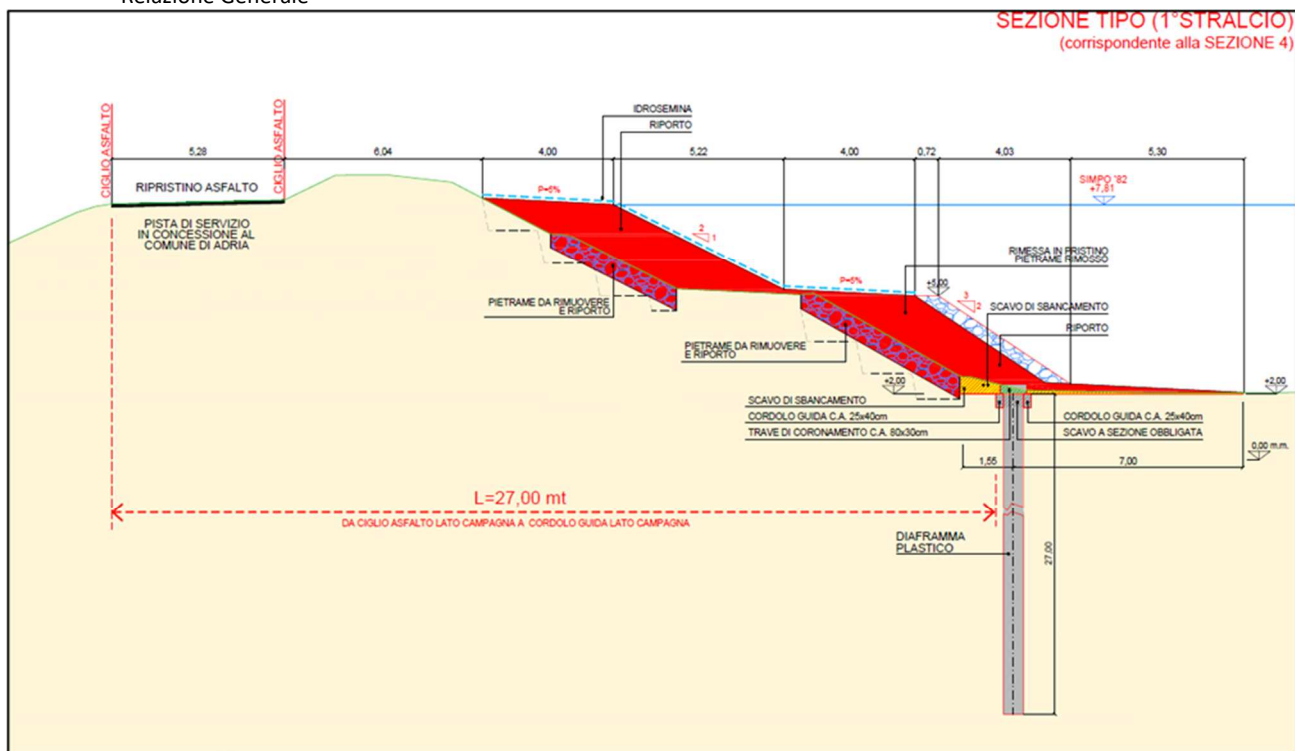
Sezione Tipo - estesa diaframma 510 m - estesa ringrosso 520 m – profondità diaframma 27 m
